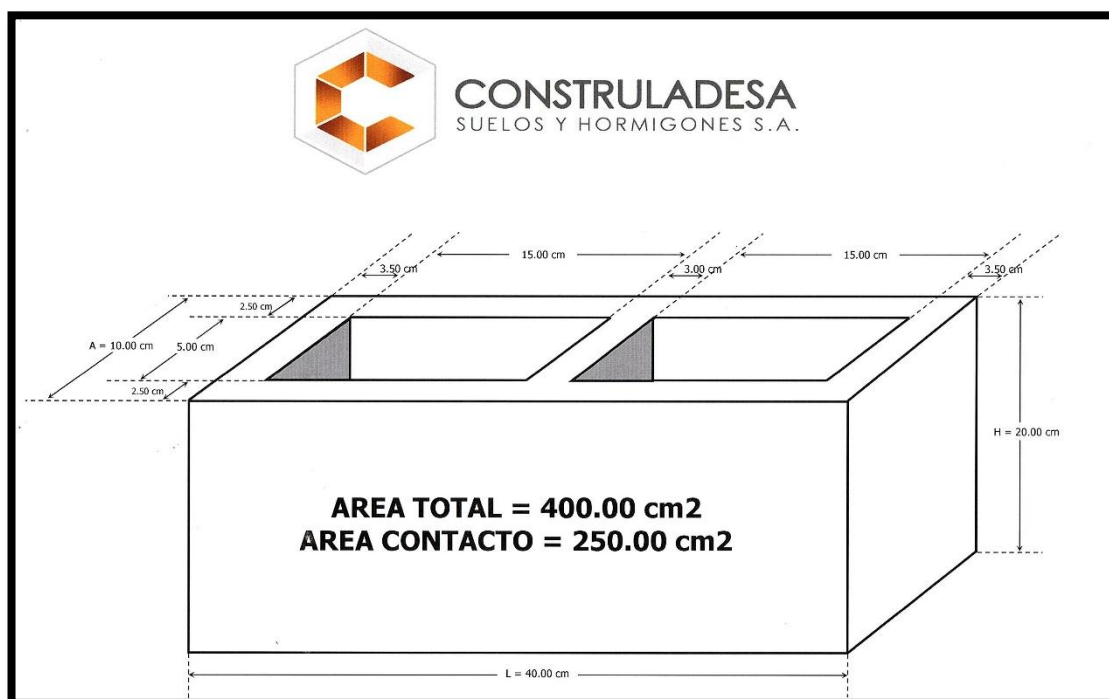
Propuesta de dimensiones de bloque de mampostería
